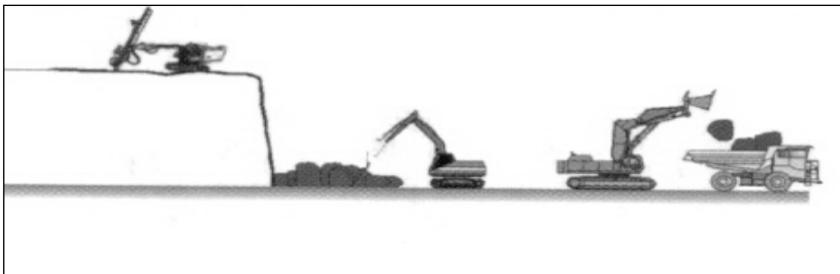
Sistema de carregamento e transporte usualmente utilizado em pedreiras. Esquematização mostrando sistema escavadeira/caminhão.
